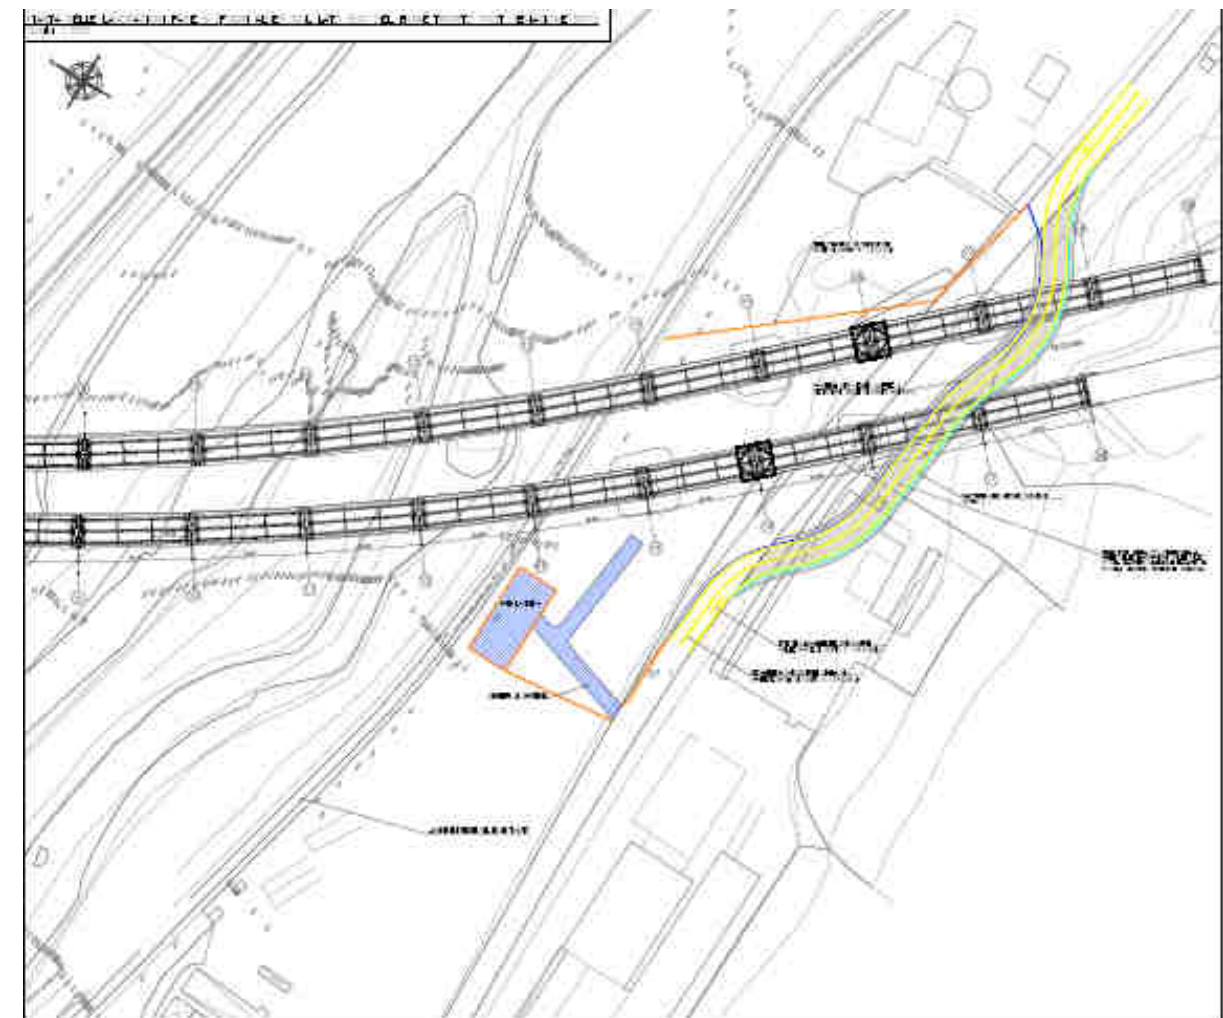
per l'ultimo tratto di cantiere è prevista la deviazione temporanea della viabilità locale come indicato nello stralcio planimetrico
